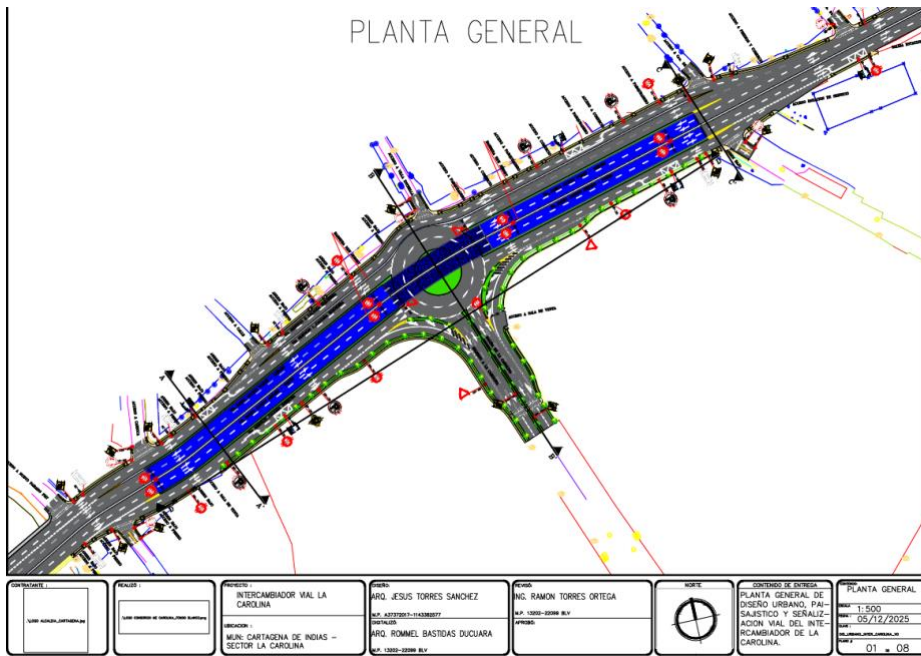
Planos planta principal. Fuente: Solicitante.
